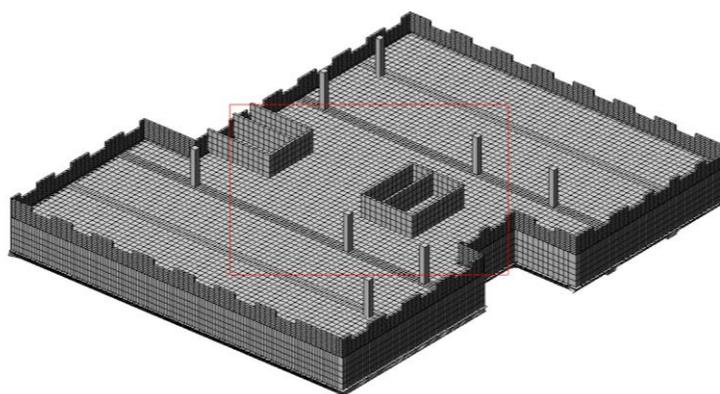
Схема этажа с разрушенными колоннами и стенами монолитного здания
